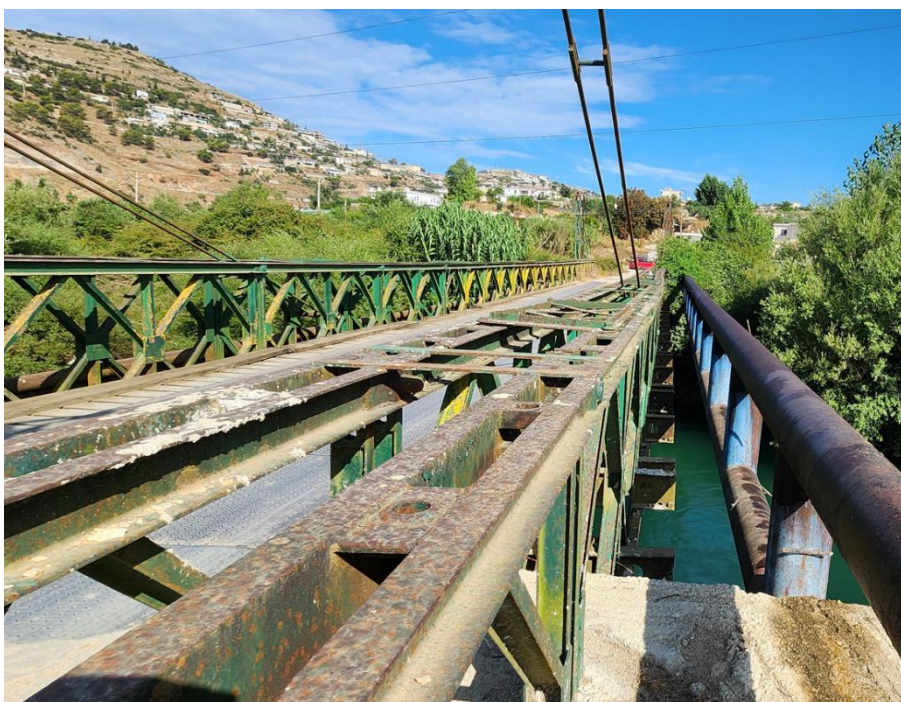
Foto të gjëndjes ekzistuese të elementeve strukturorë të urës Bejli
